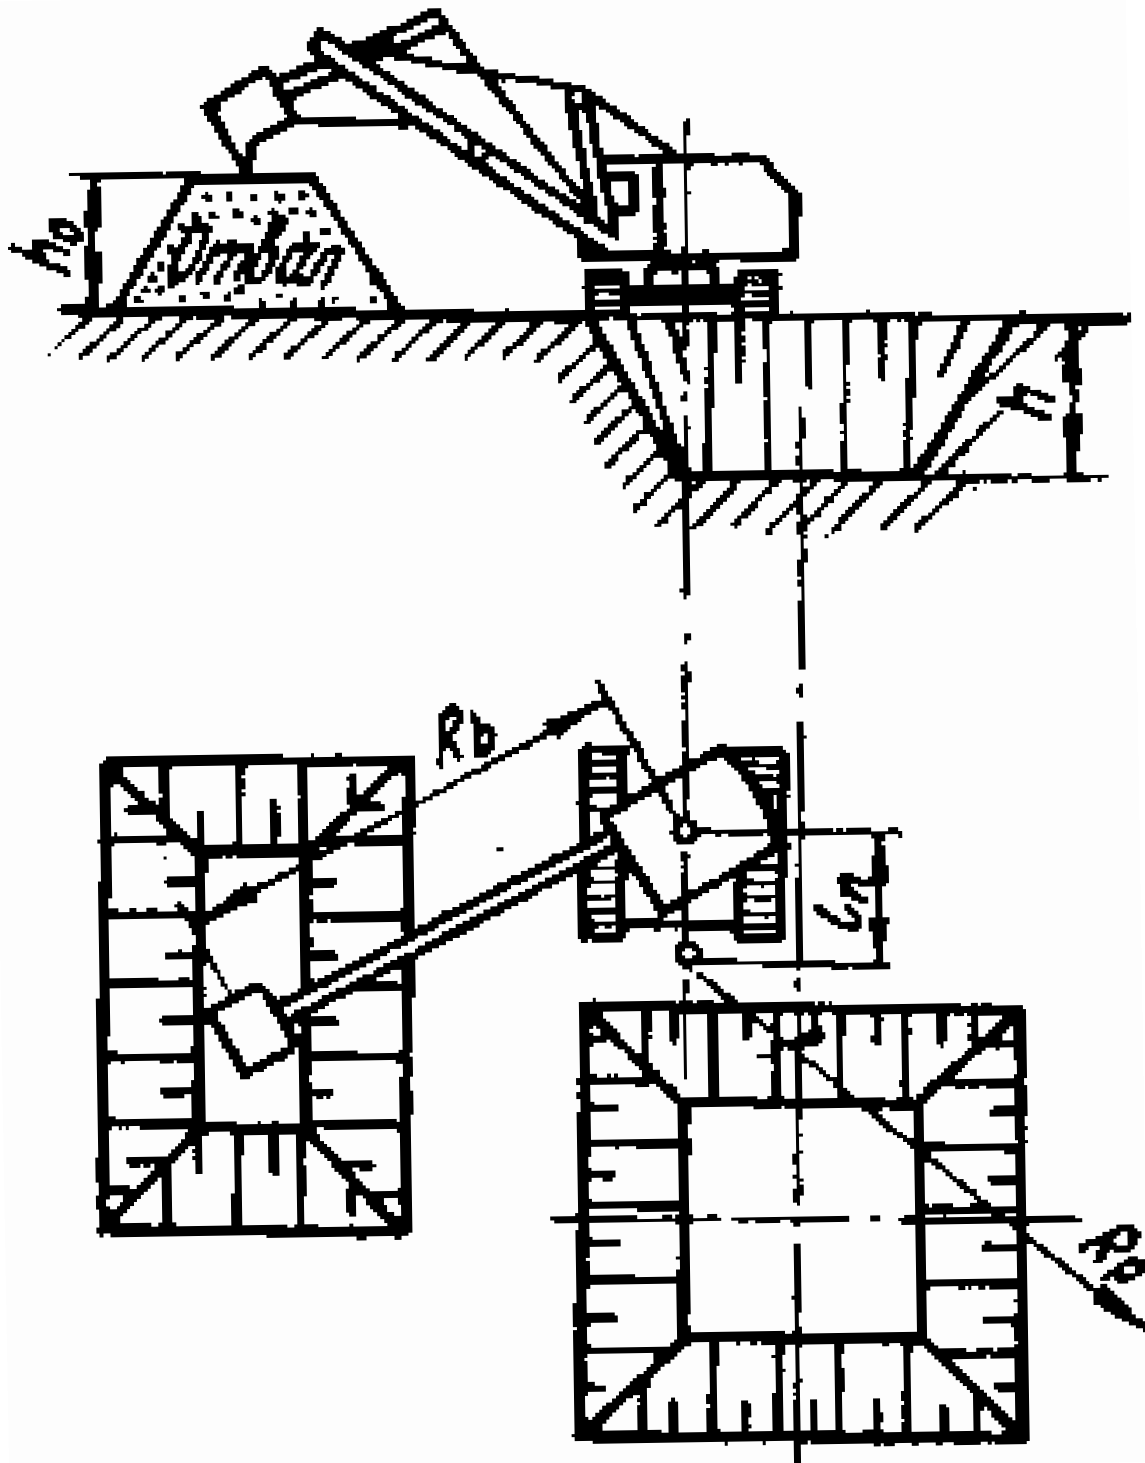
Разработка котлованов под отдельно стоящие фундаменты экскаватором, оборудованным обратной лопатой.
